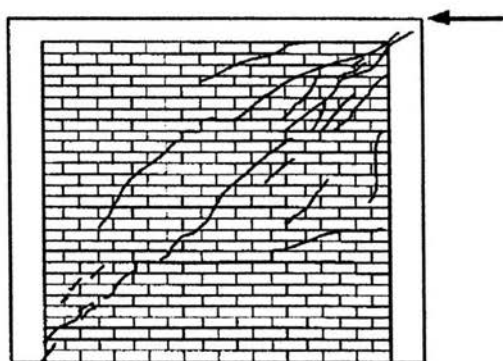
Ensaye en voladizo de un muro de mampostería confinada
